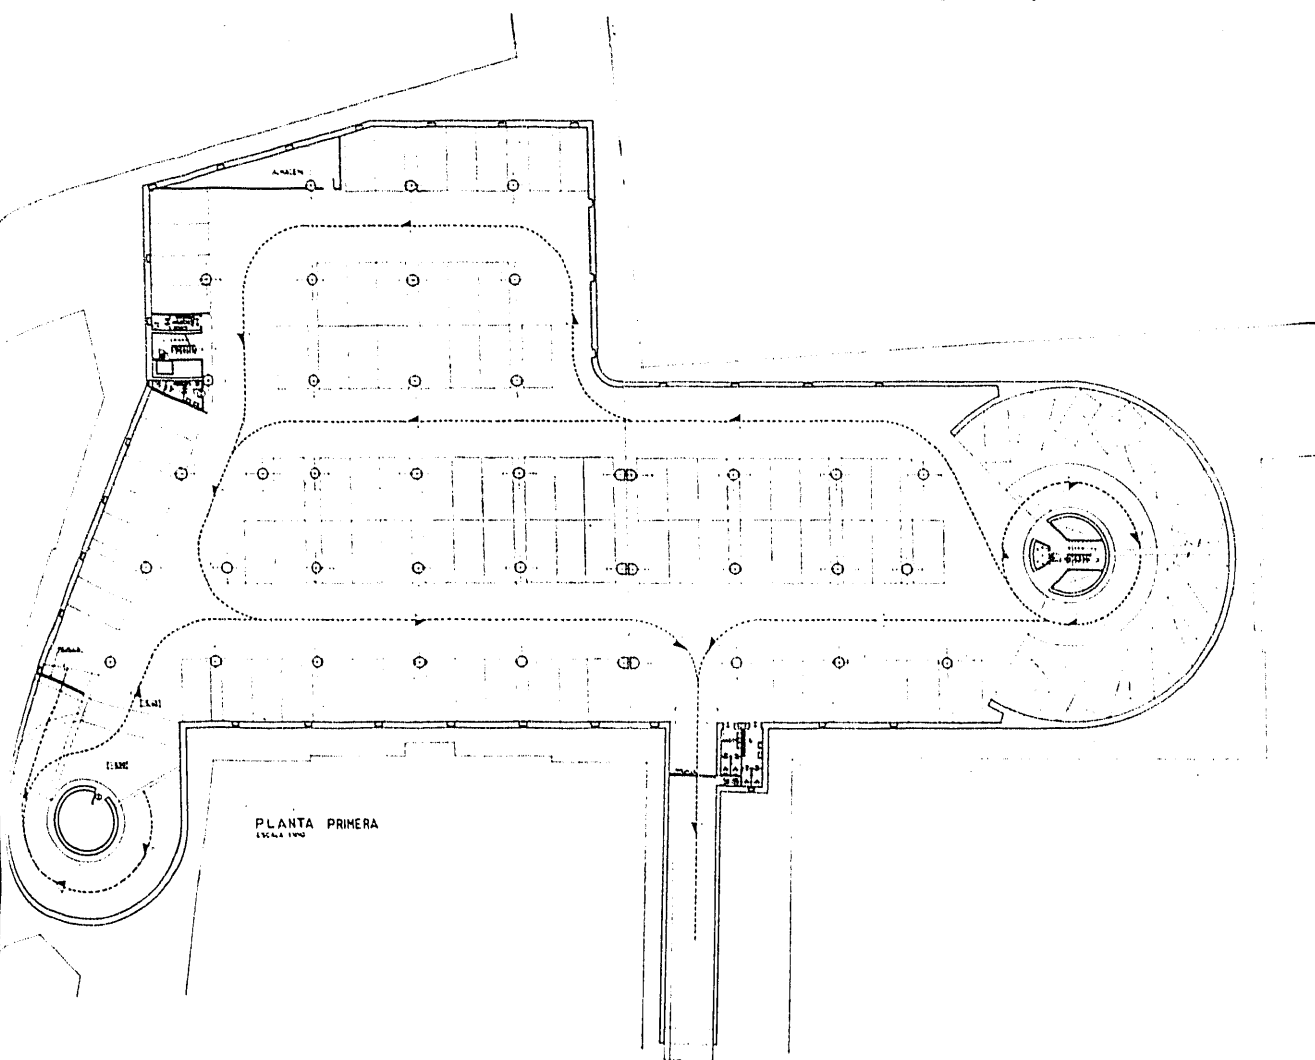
Estructura y disposición del aparcamiento de la Plaza de las Descalzas.
